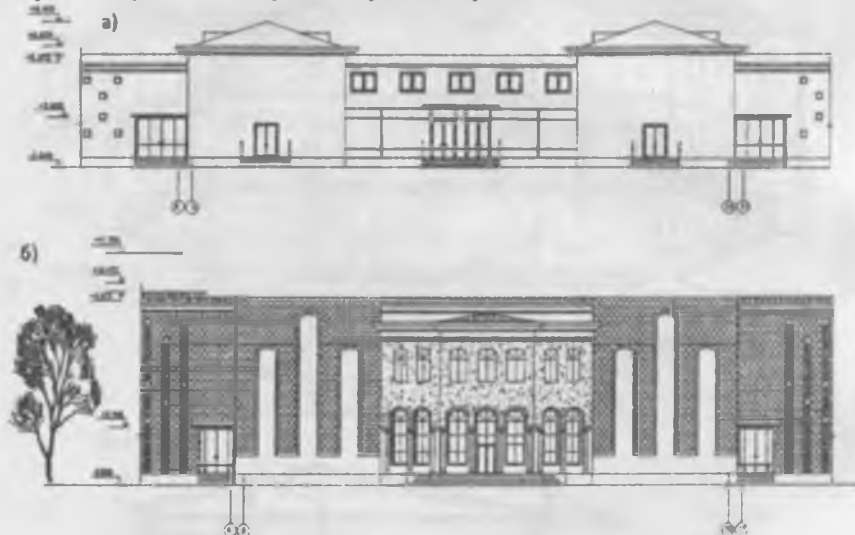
Фасады здания до (а) и после реконструкции (б).
